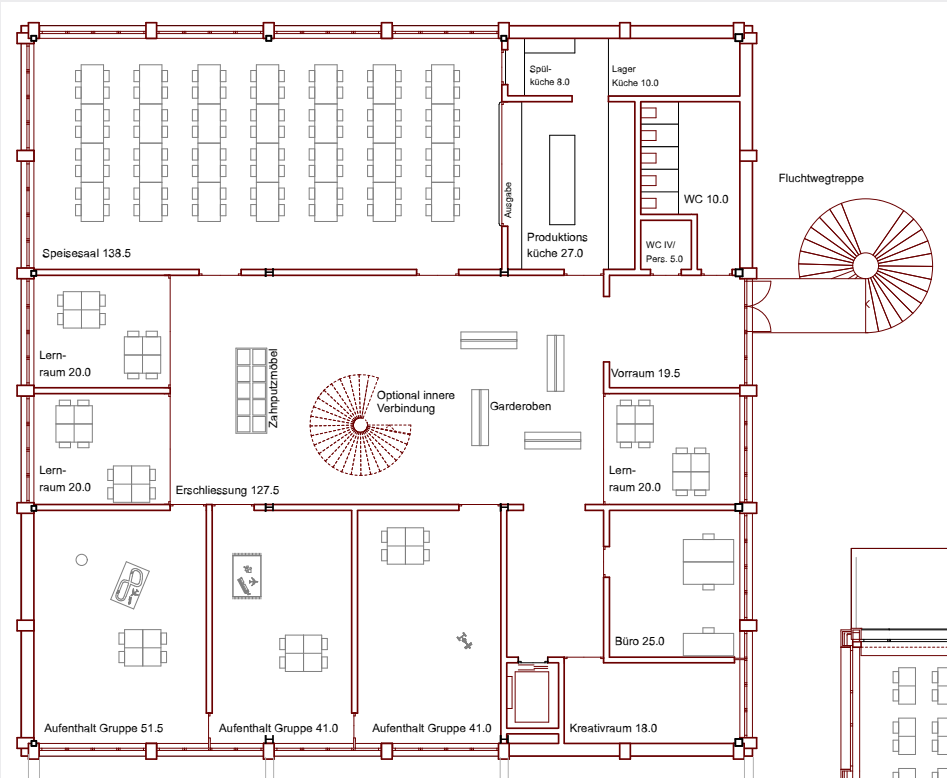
Grundriss Tagesstruktur 1. OG (Variante)
